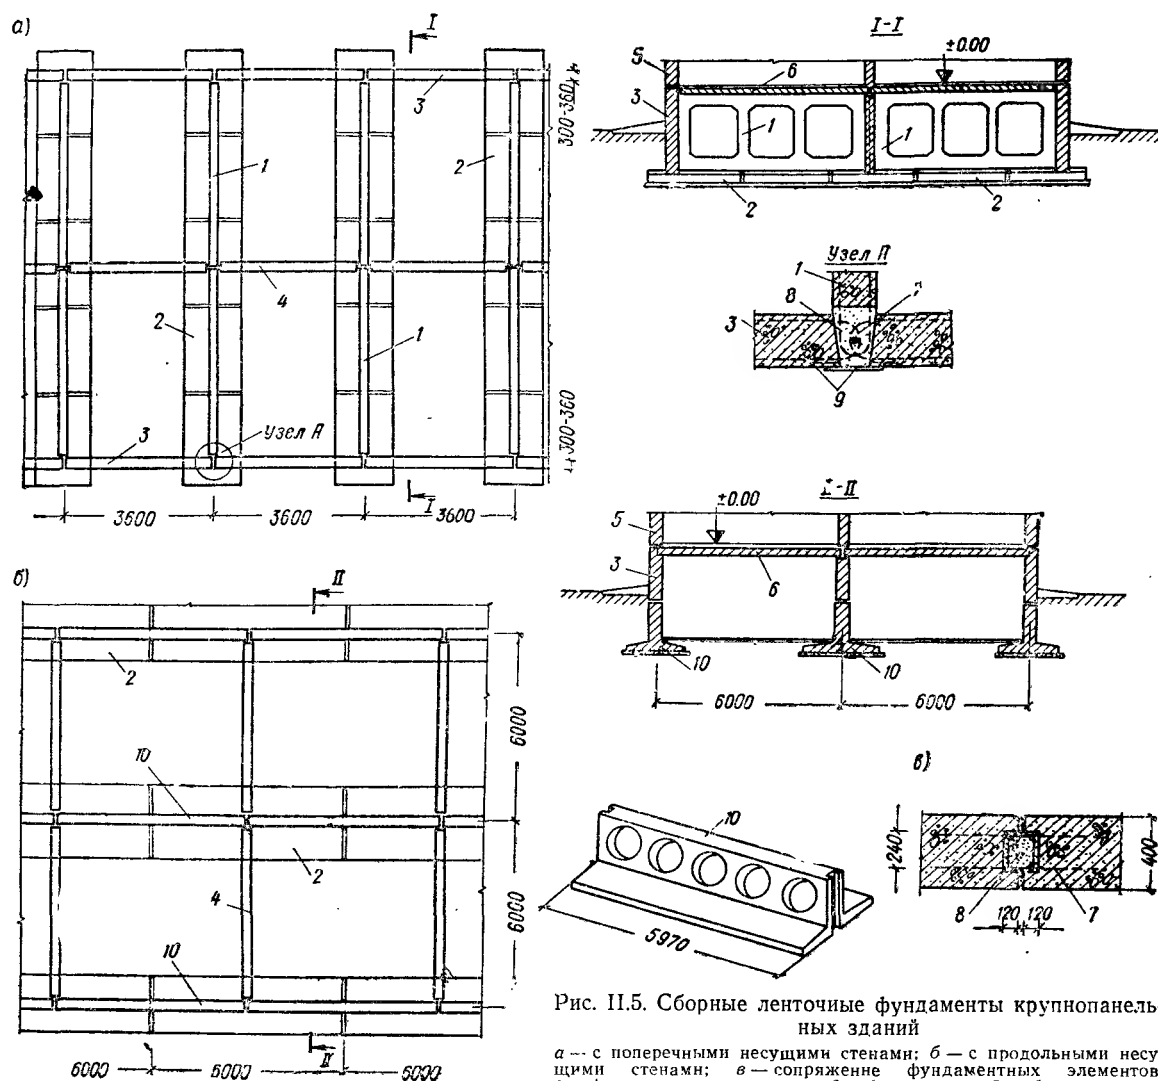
Сборные ленточные фундаменты крупнопанельных зданий
